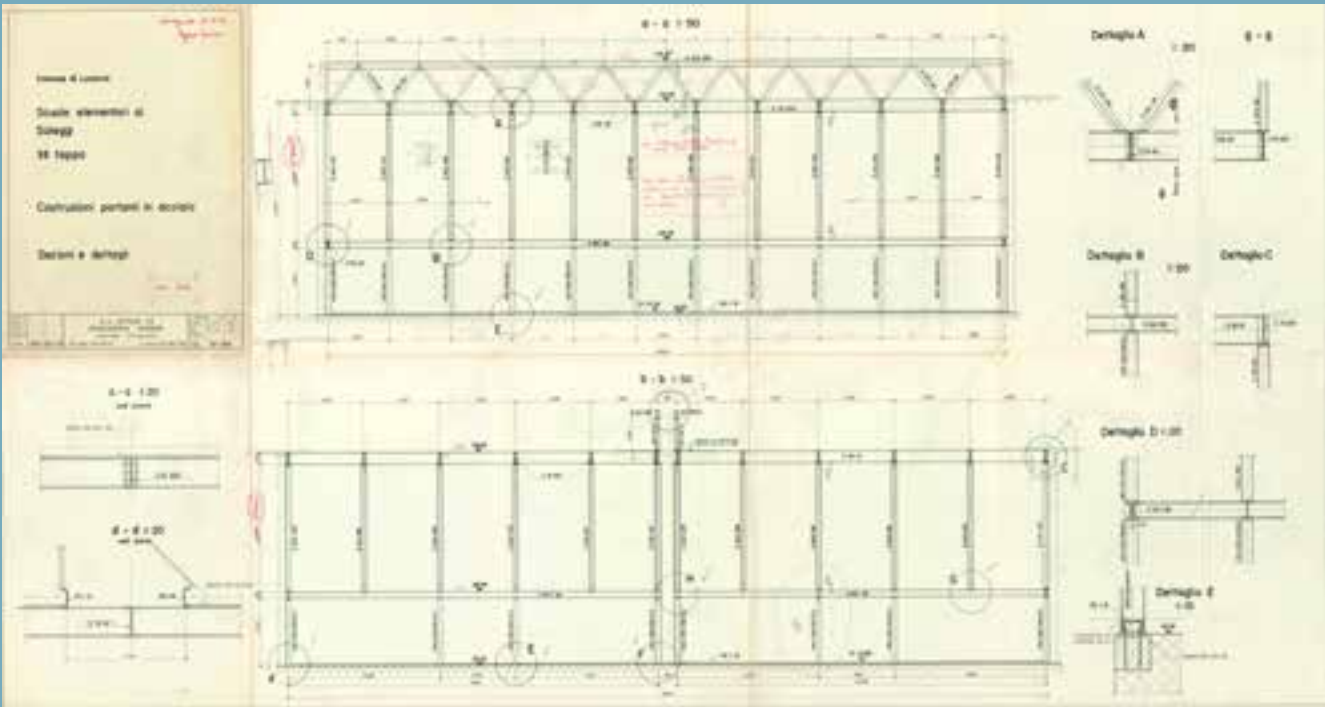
Figura VIII. Ufficio di Ingegneria Maggia, Struttura metallica della palestra, sezioni e dettagli, 15 febbraio 1977 (AIMME).
